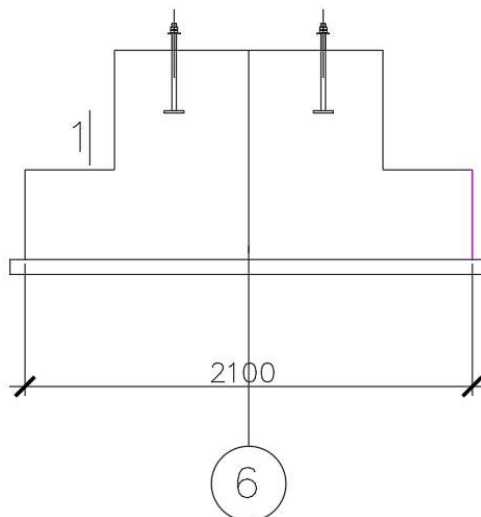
Расчетная схема при определении площади арматуры
